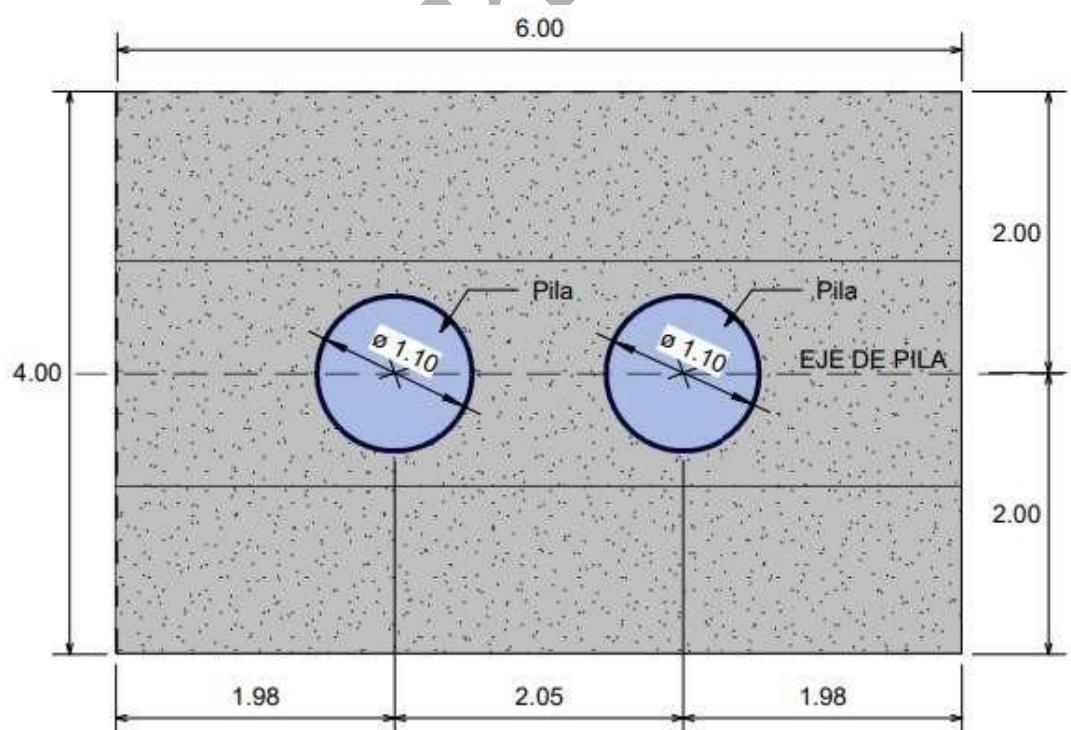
Vista en Planta de la Zapata de Fundación en el Puente Calle Bulnes
